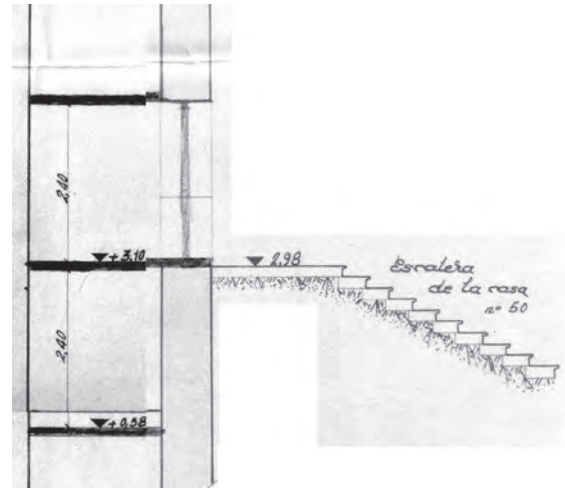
32. SECCIÓN TRANSVERSAL
